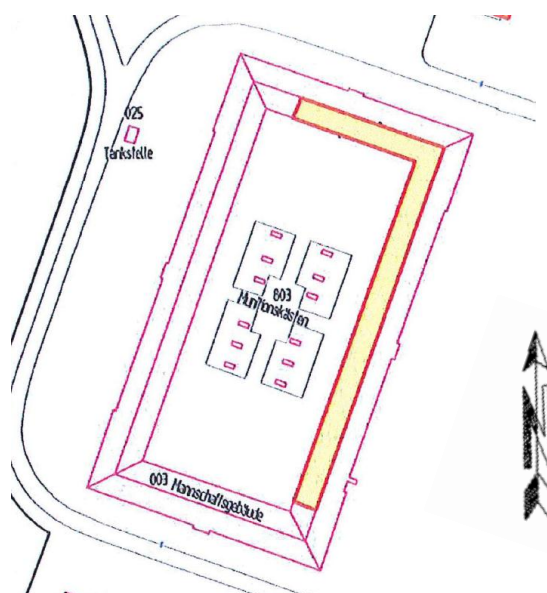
Grundrissauszug vom Lageplan mit gelber Markierung der möglichen Errichtung von Solar- und Photovoltaikanlagen auf den Dachflächen des Bestandsobjekts 3 laut Bundesdenkmalamt [7]
